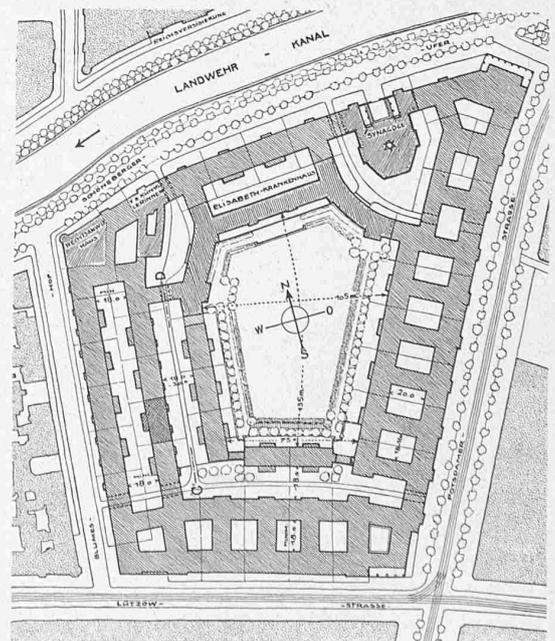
Lageplan der Variante. — Masstab 1:4000.
